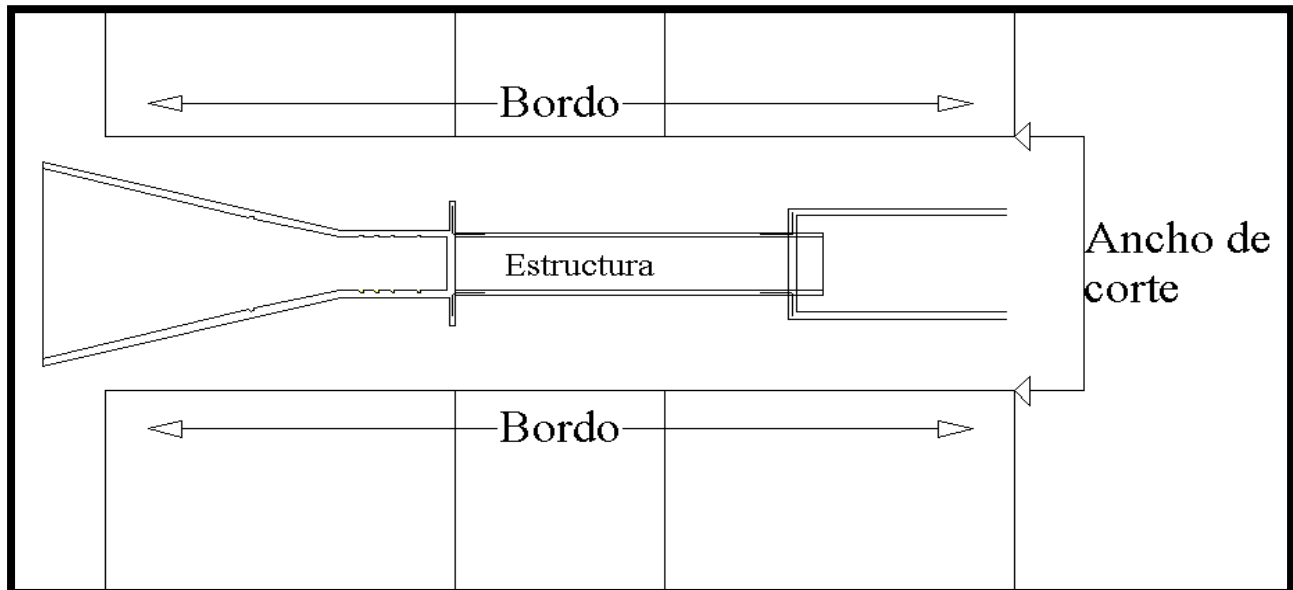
Corte en el bordo necesario para la construcción de la estructura.
